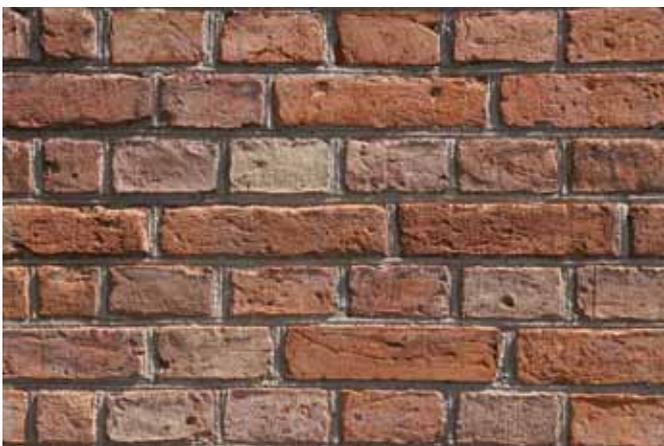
Berlin, Nazarethkirche. Handgestrichene Backsteine mit Quetschfalten
